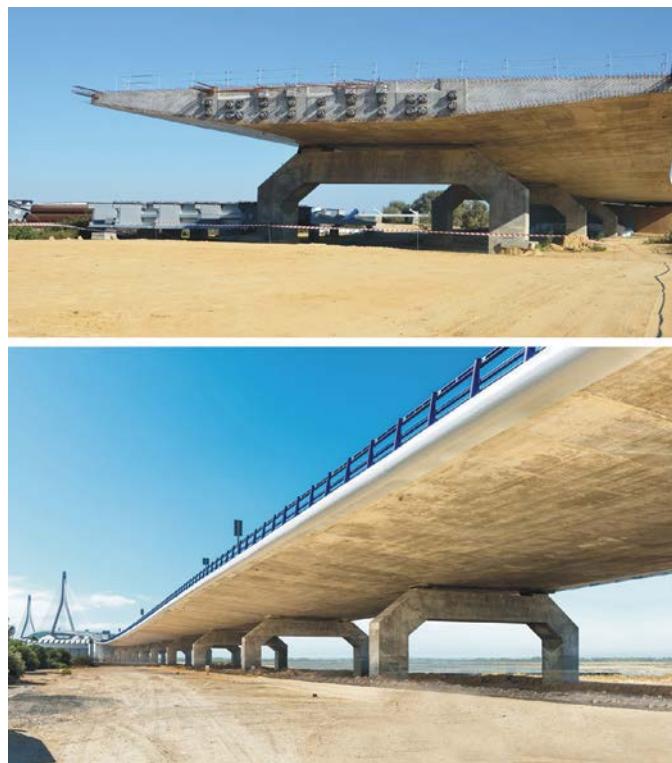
Vista del viaducto de acceso lado Puerto Real, canto 2,00 m.
